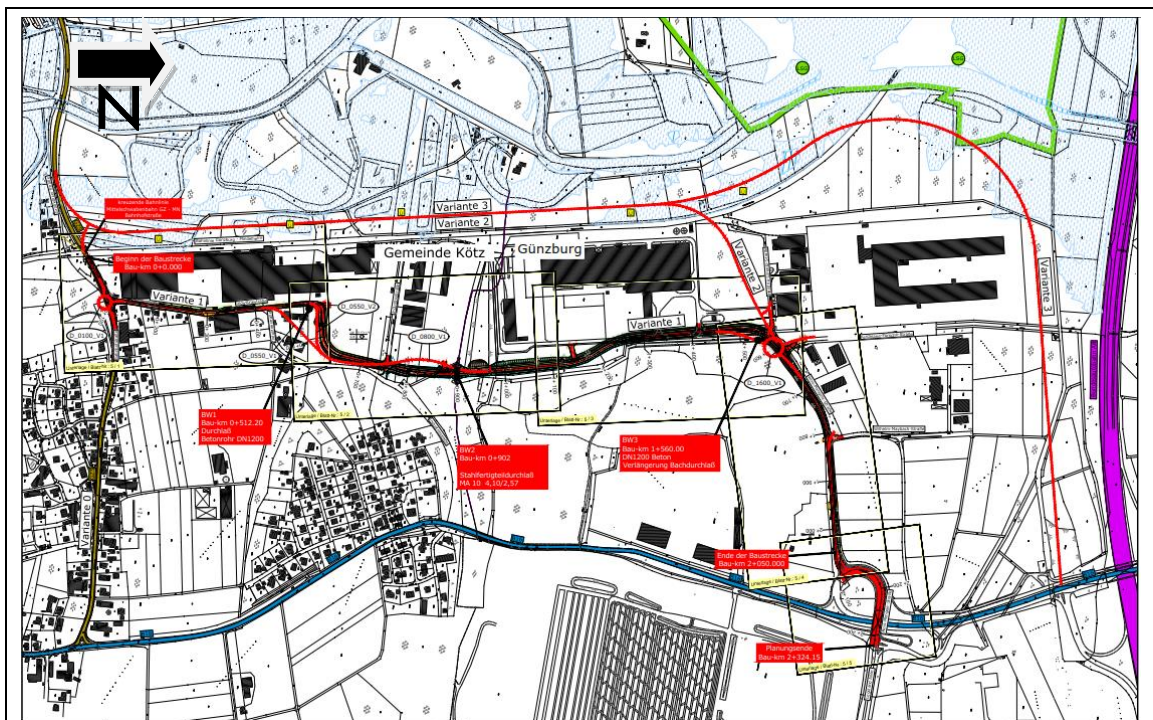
Übersichtsplan des Baubereiches, Stand 31.01.2021, Quelle: Übersichtsplan des Feststellungsentwurfs, Staatliches Bauamt Krumbach
